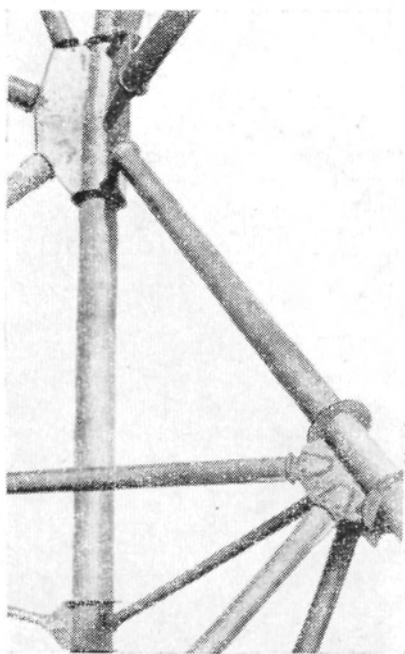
Крепление решетки трубчатого сечения к поясам башни
